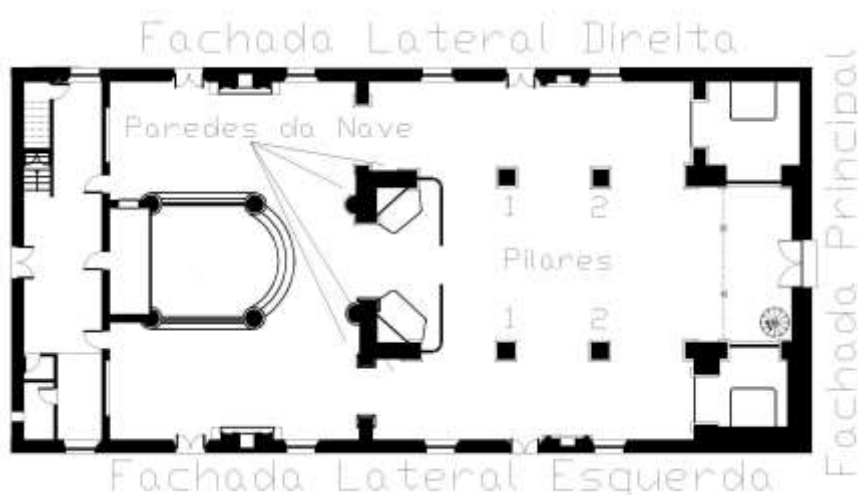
Planta baixa do térreo da edificação. Fonte: IPHAN[10]
